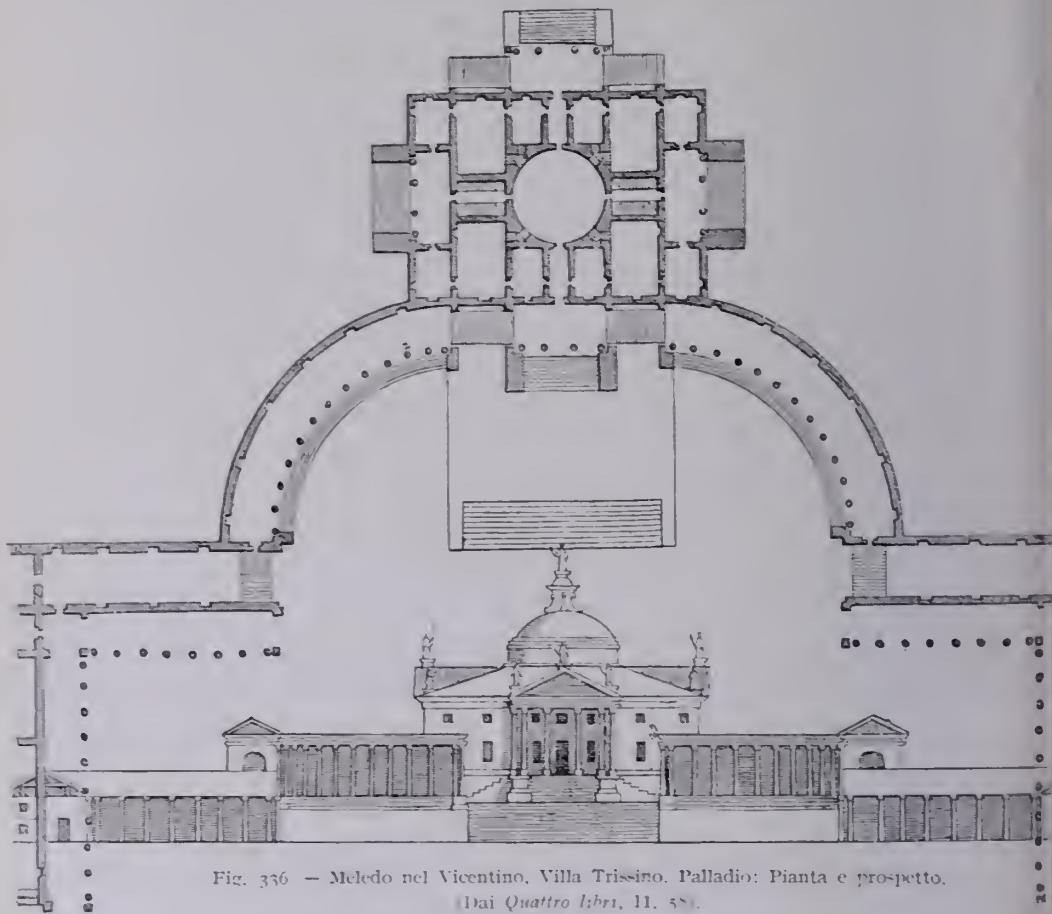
Meledo nel Vicentino, Villa Trissino. Palladio: Pianta e prospetto.
